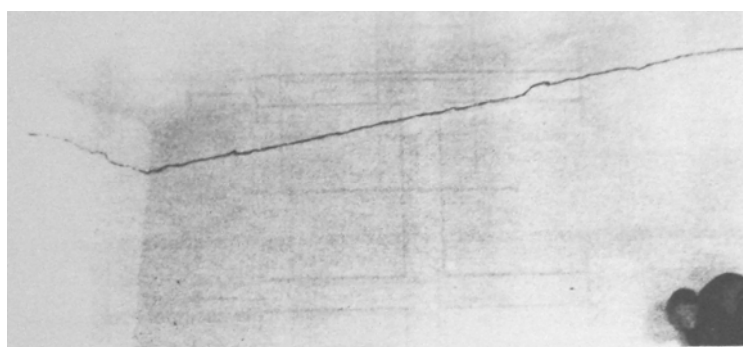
Fissura com abertura regular no topo da parede, resultante do abaulamento e da dilatação plana da laje da cobertura (Fonte: THOMAZ)
